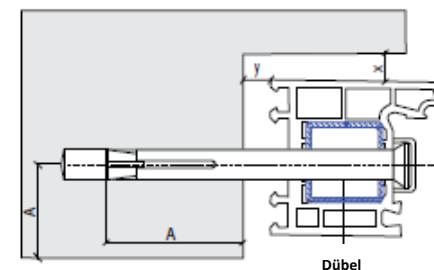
Montage des Fensterrahmens mit Montageschrauben
